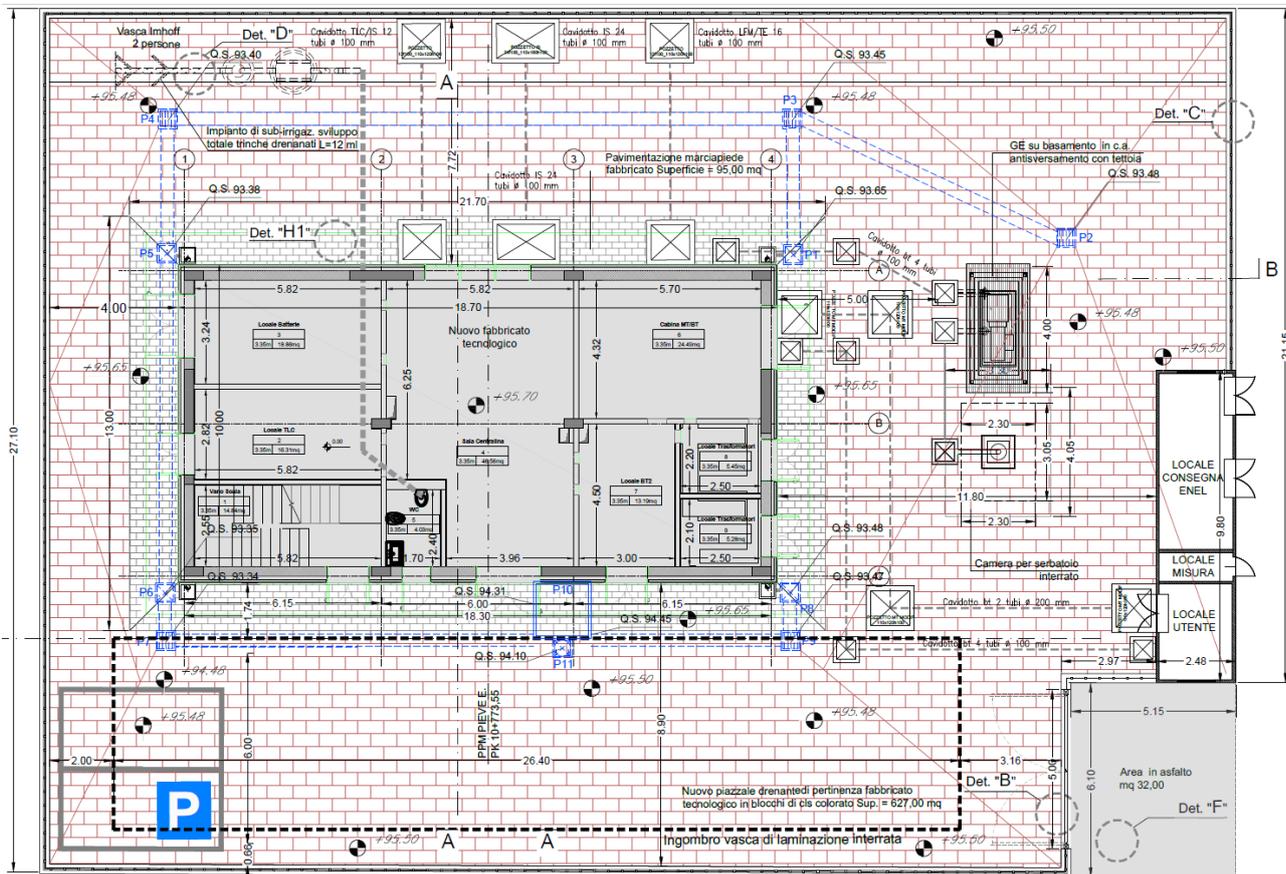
PPM Pieve Emanuele - Estratto della planimetria idraulica
